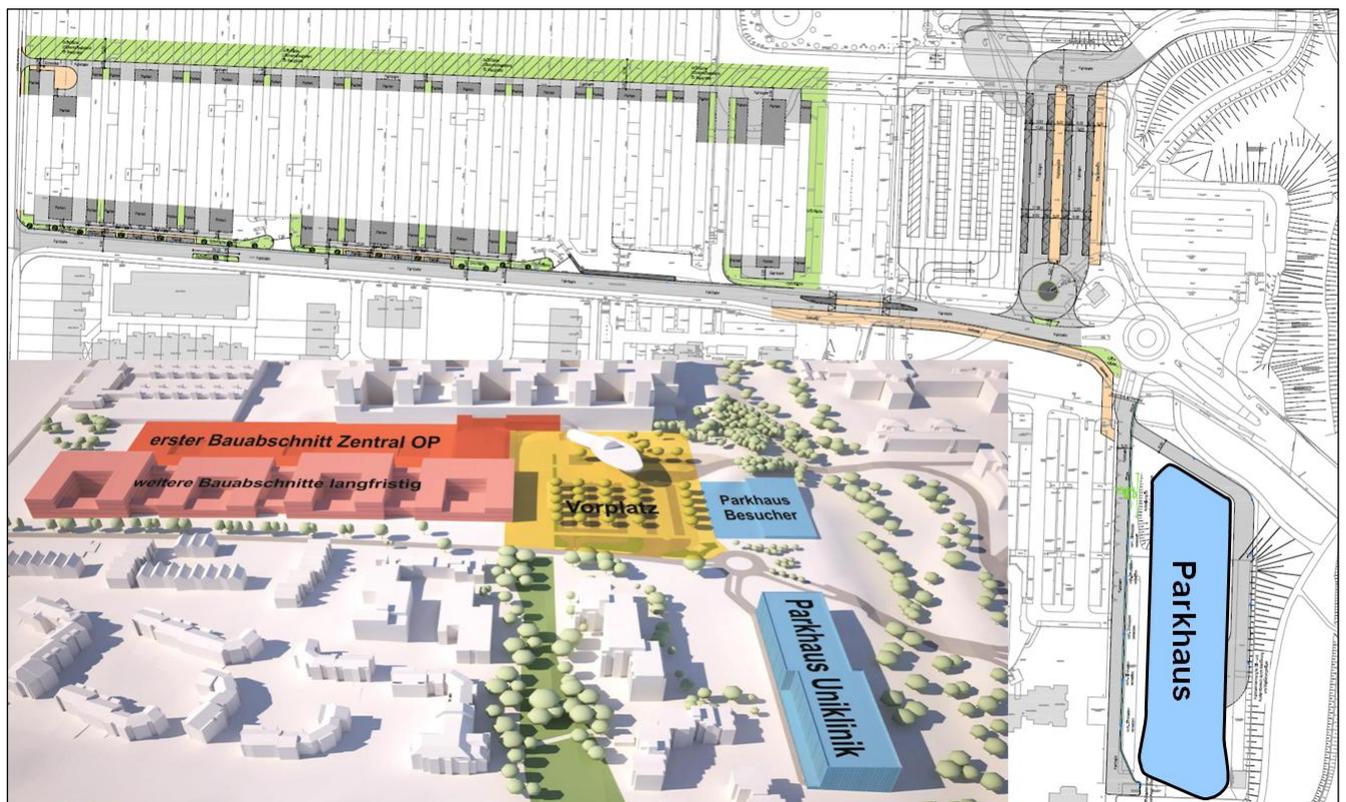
Lage des Parkhauses im Stadtmodell und auf dem Lageplan der Vorplanung (Quelle: BKI)
